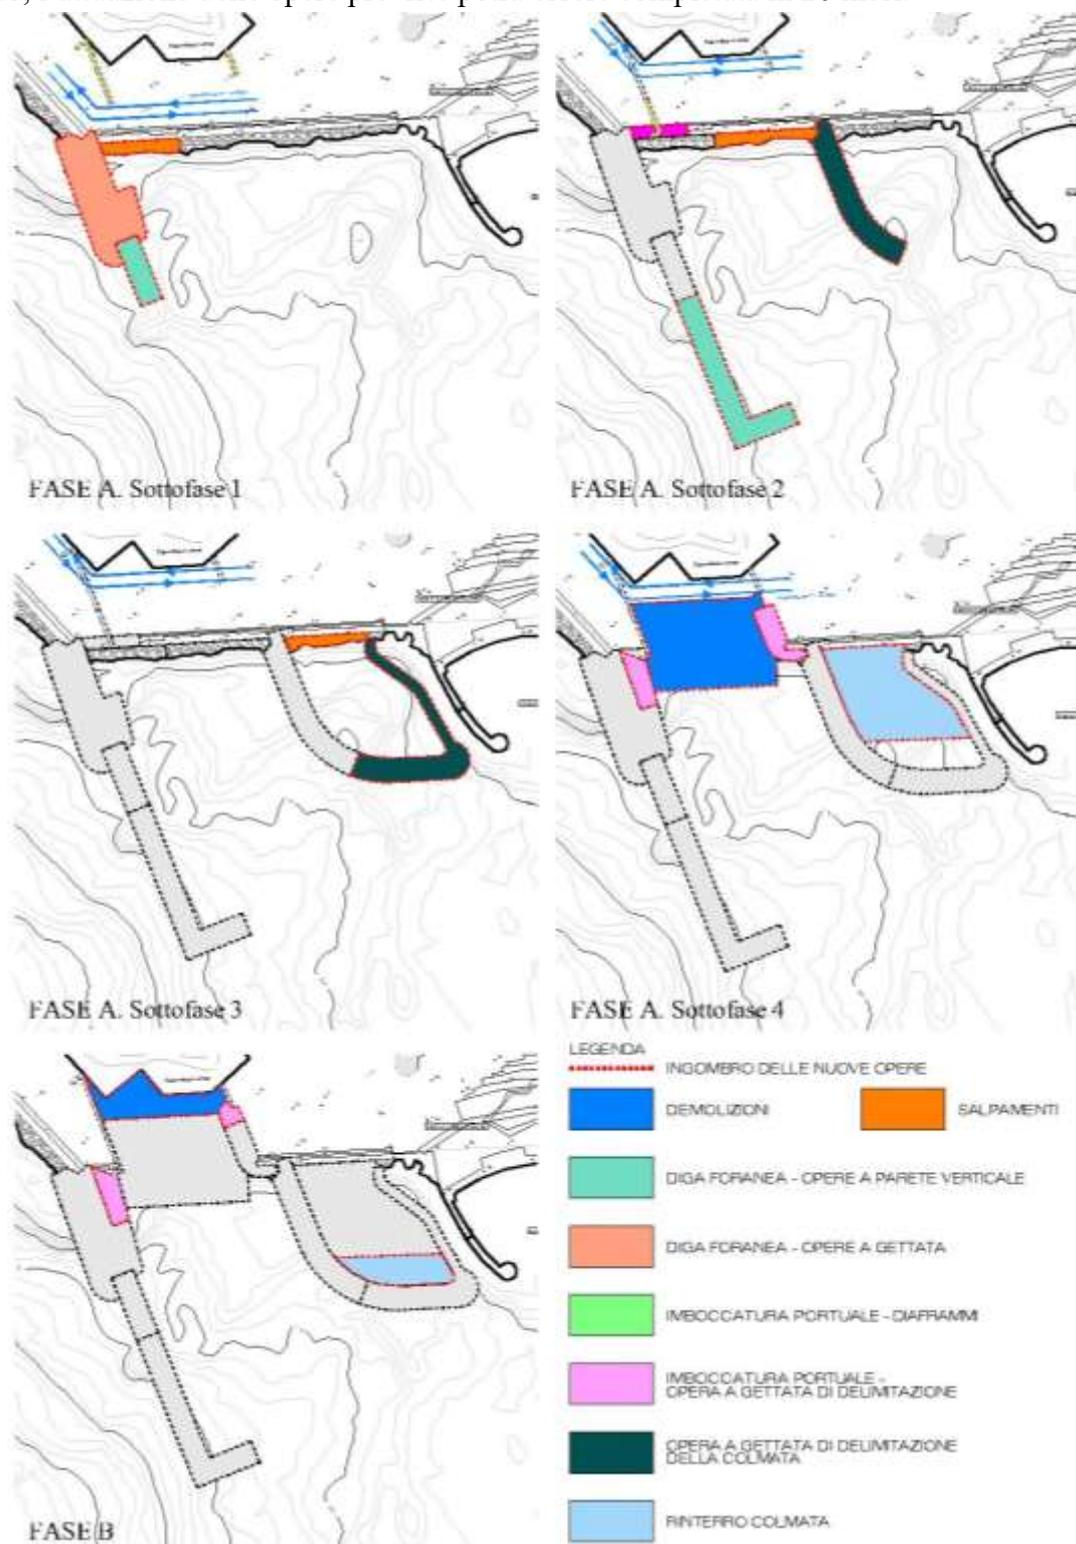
Area nuovo accesso al bacino storico. Articolazione delle lavorazioni della prima fase (A) e della seconda fase (B)
